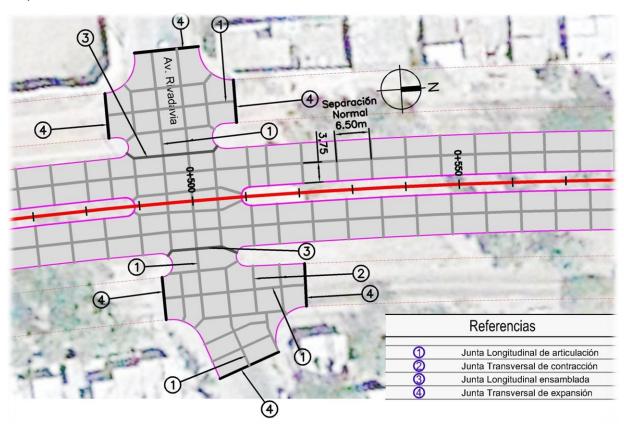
Planimetría de juntas del proyecto de Av. Lugones Norte intersección Rivadavia.
